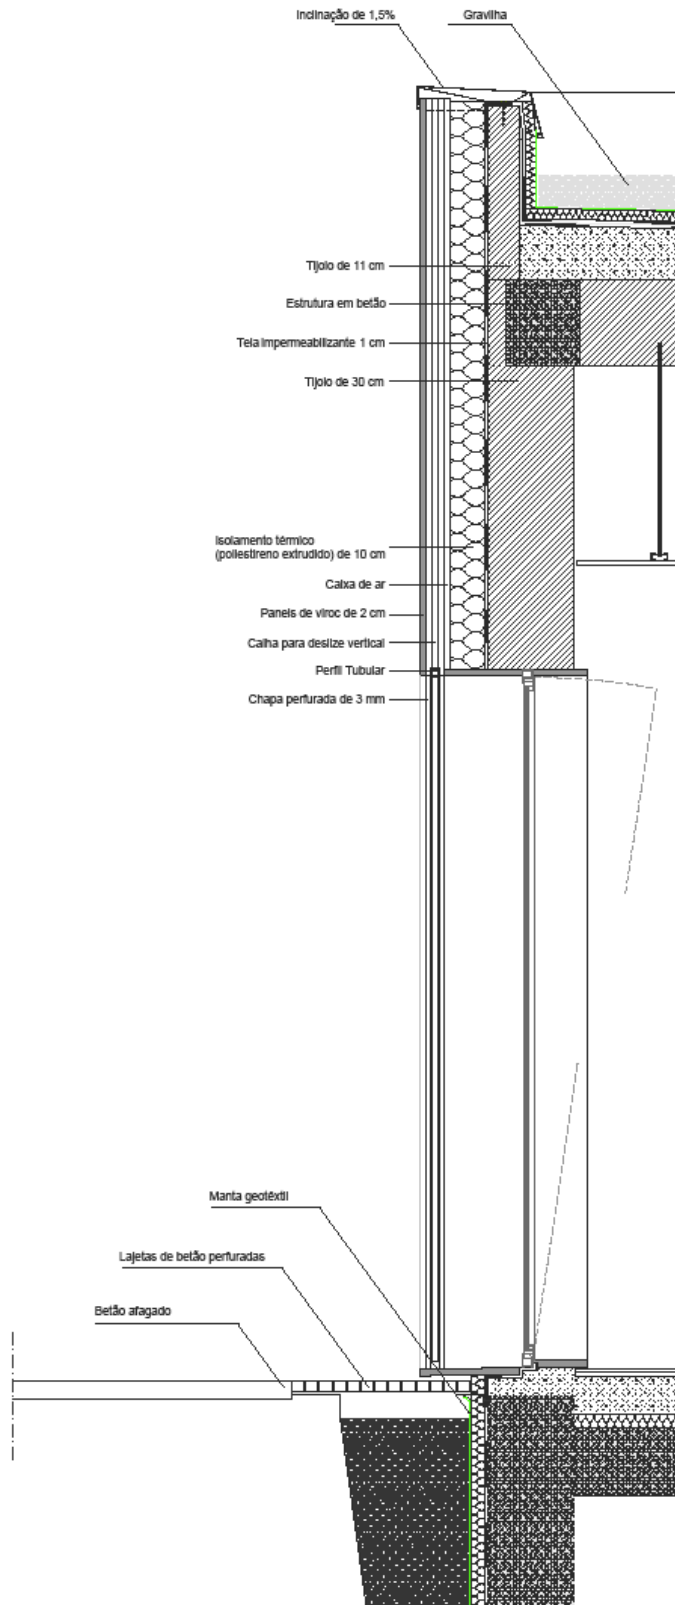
Pormenor construtivo da fachada, em corte. Fonte: Elaboração própria.
